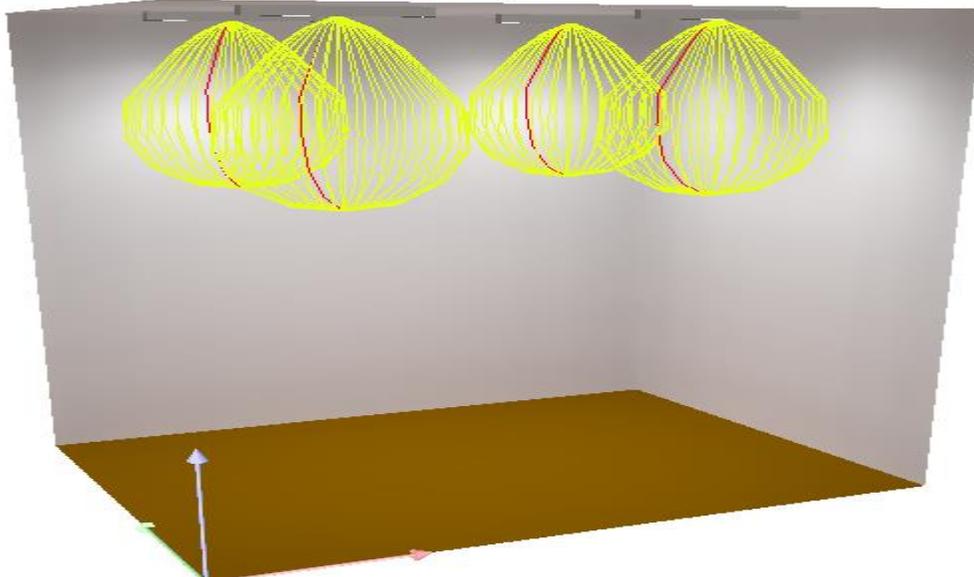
Sebaran Cahaya pada Ruang Wakil Dekan I / Ruang Staff Ahli
